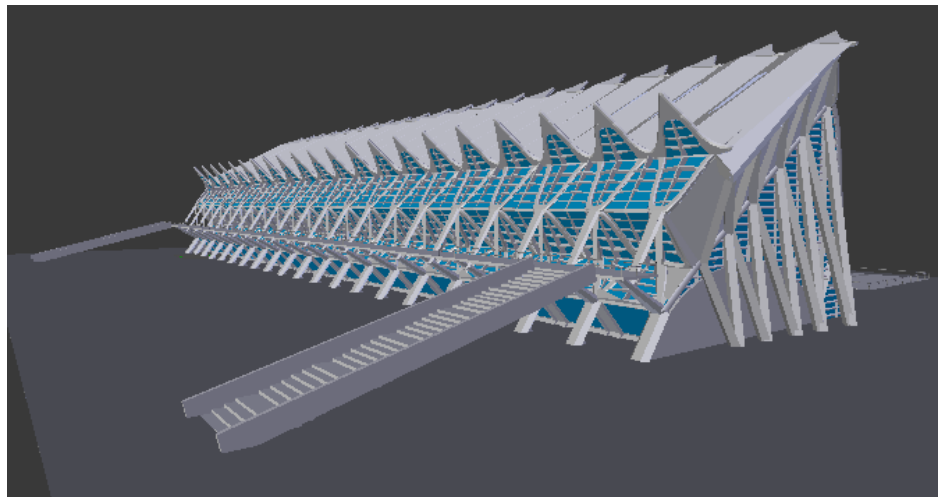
Modelado en Blender, fachada sureste finalizada
